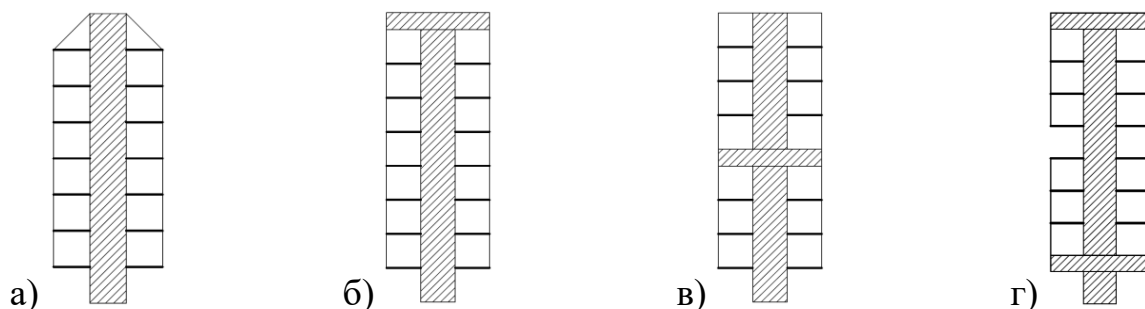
Здания консольно-подвесной конструктивной системы: а) с подвешенными к стволу по периметру консольными перекрытиями в уровне каждого этажа; б) с подвешенными к оголовку по периметру консольными перекрытиями в уровне каждого этажа; в) с перекрытиями, подвешенными к консольному поясу в уровне средних этажей или опирающимися на него; г) с двумя консольными ростверками, на которые подвешиваются или опираются перекрытия
